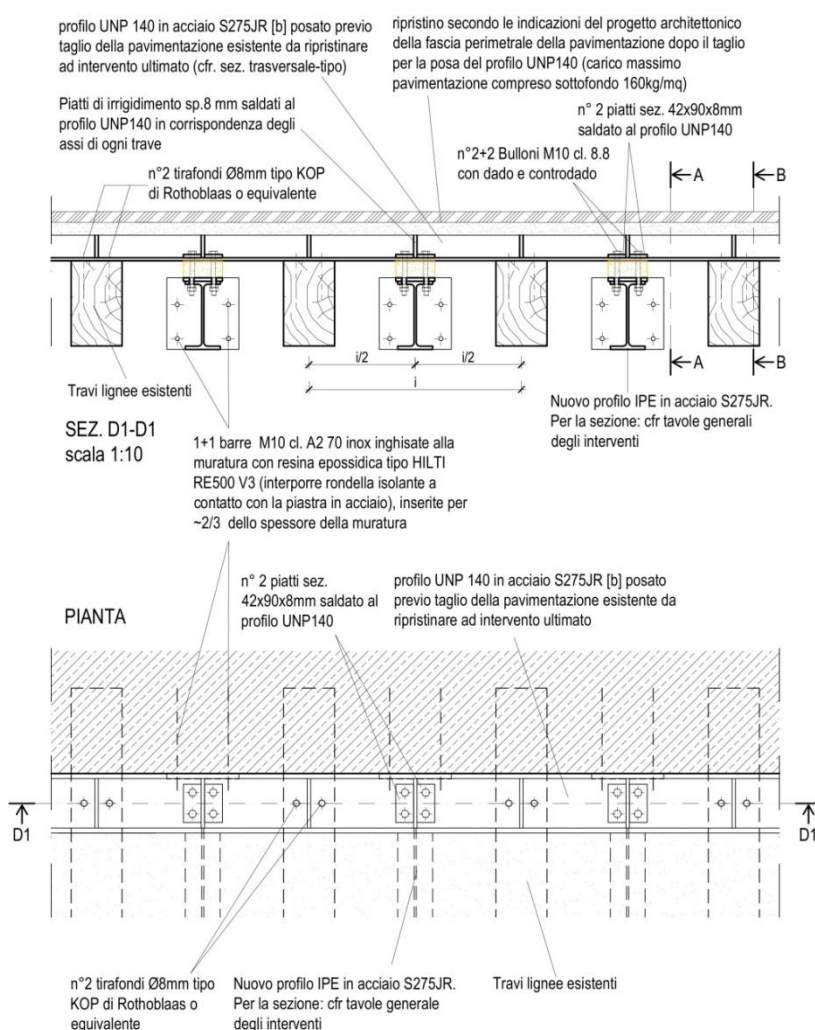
Dettaglio tipo del profilo UPN con funzione di appoggio per le travi IPE
